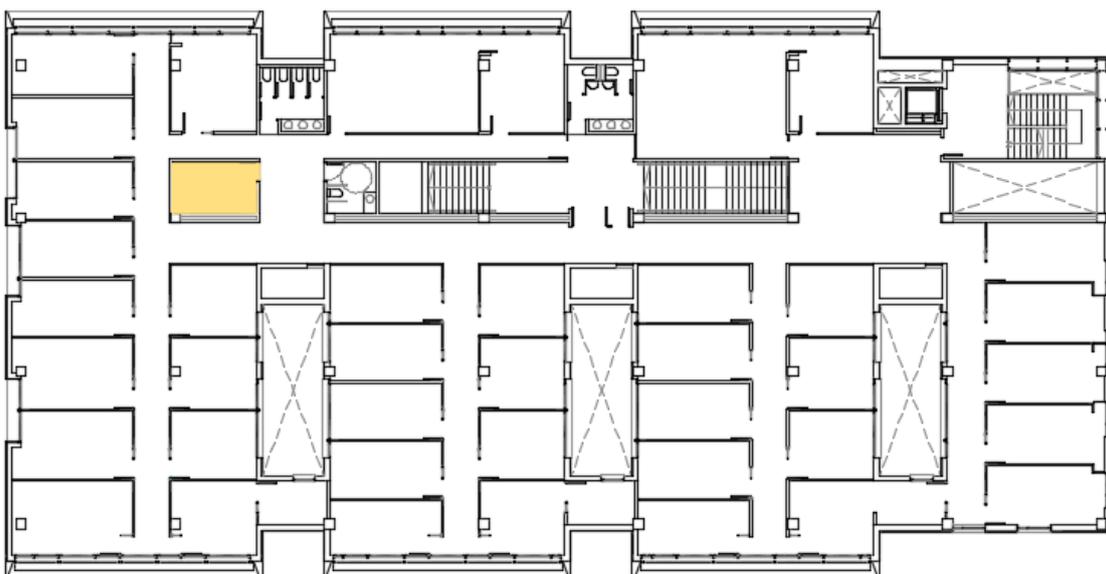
Situación RACK en Planta Segunda. Figura extraída del plano 54.
